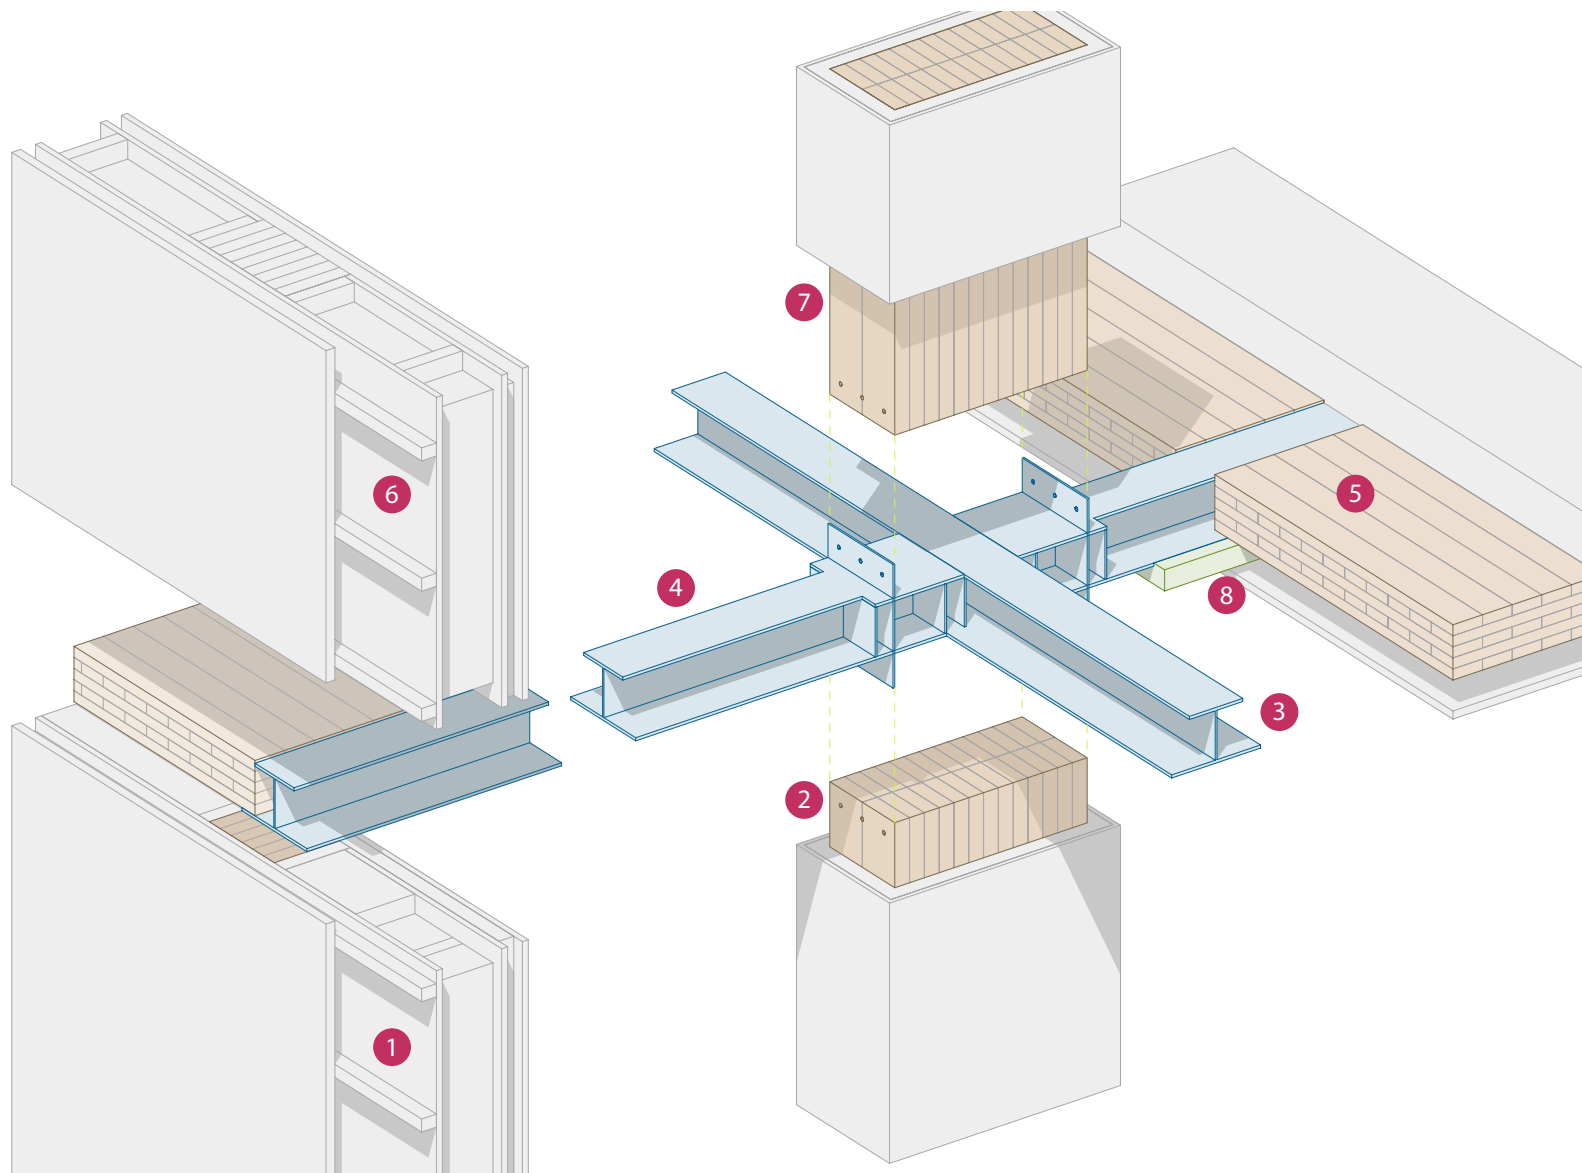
Tragwerk laut Ausschreibung - Auflagerdetail fassadenseitig (3D Axonometrie)
